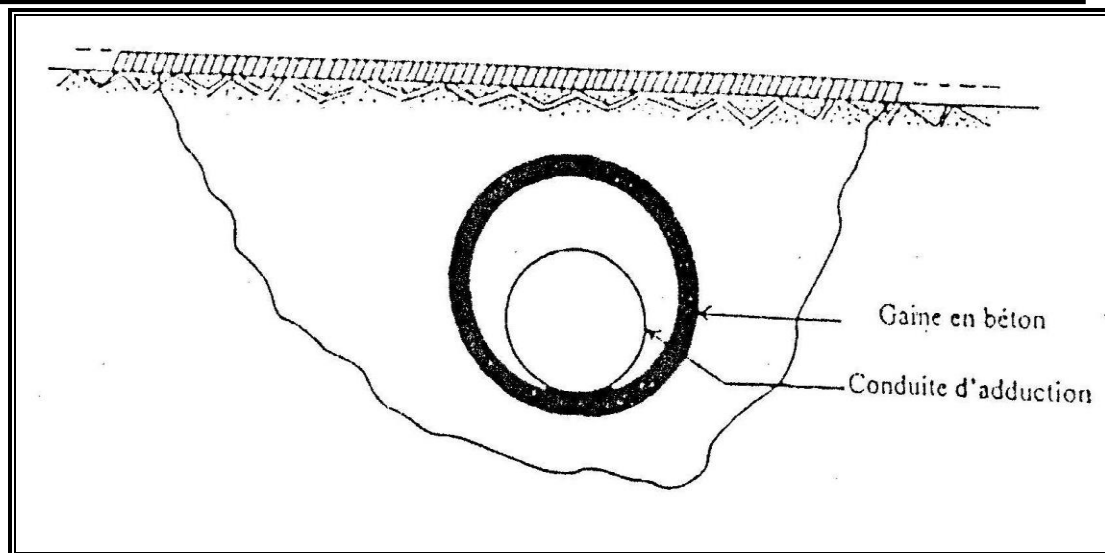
Traversée d'une route au moyen d'une gaine. [6]
